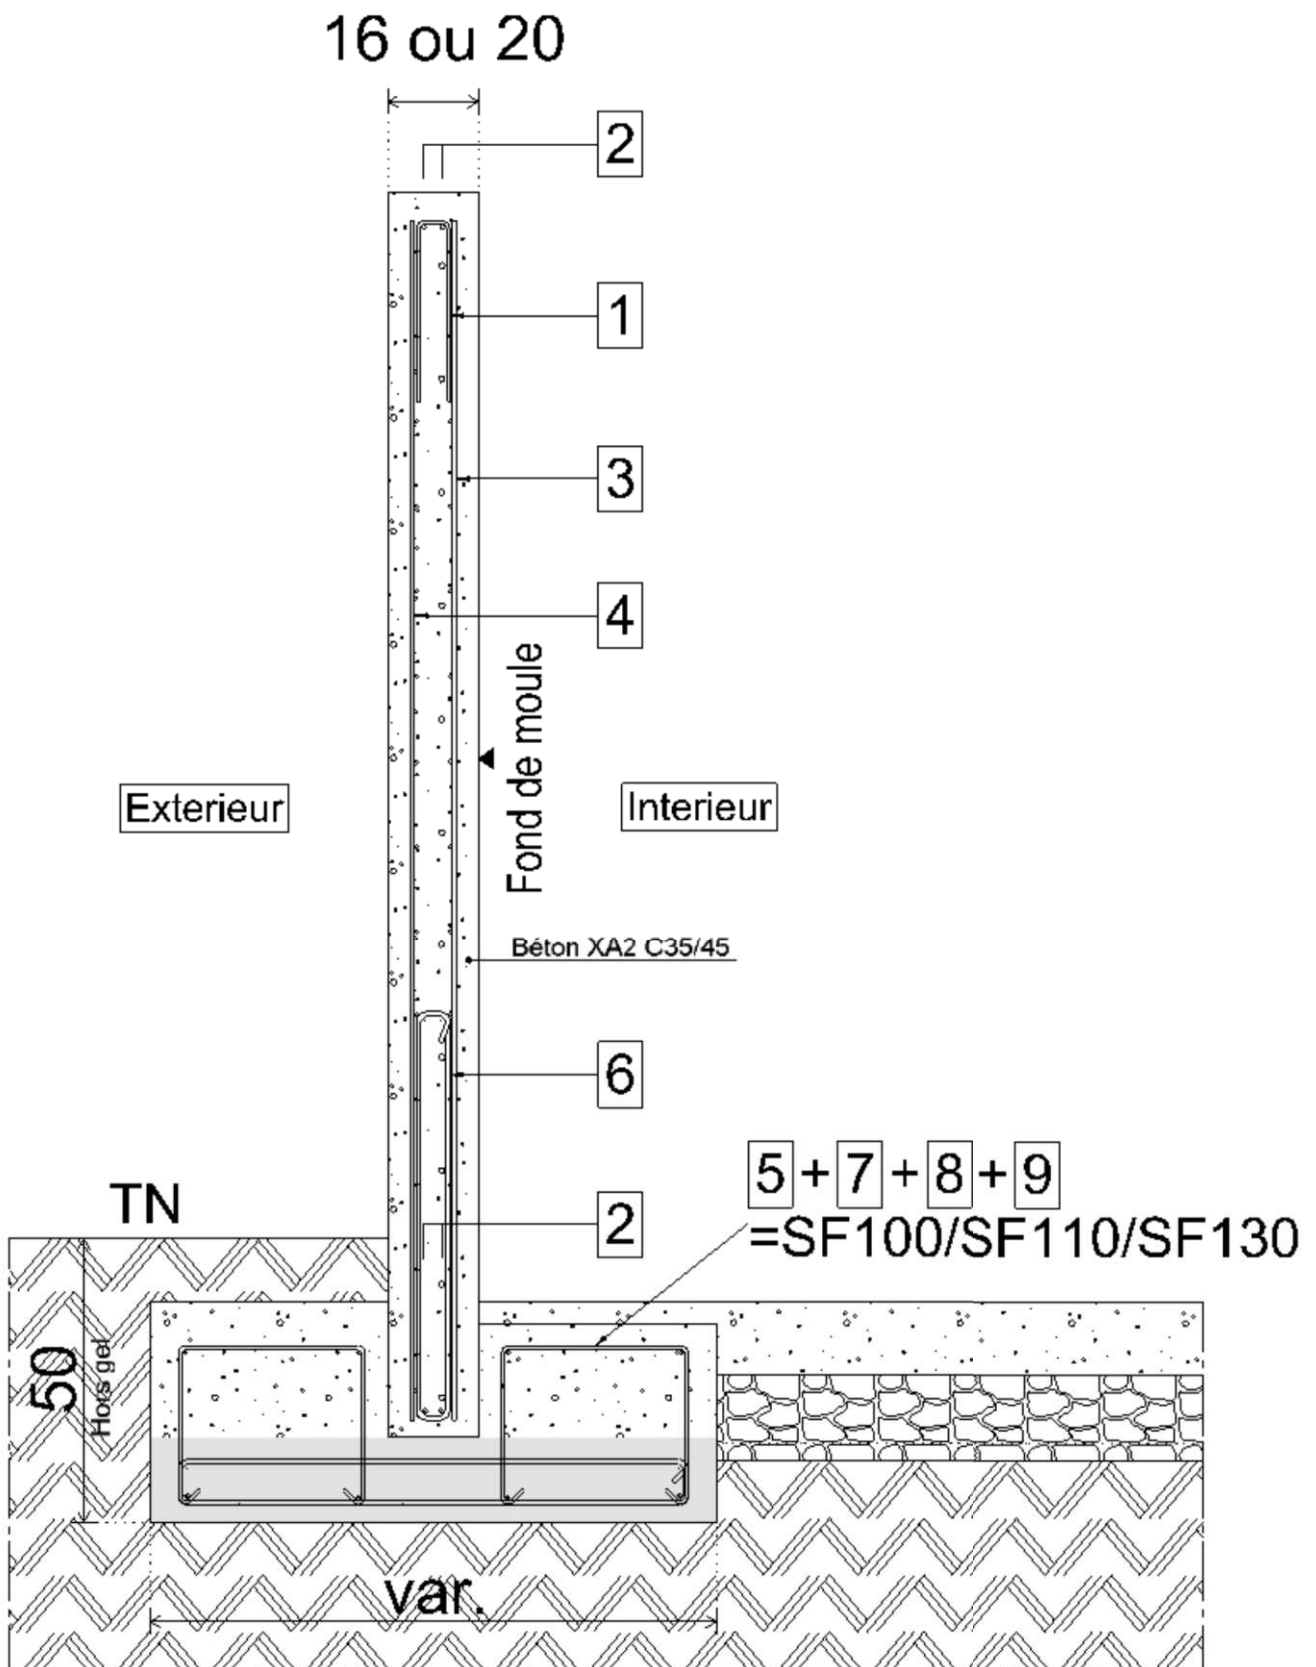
Coupe sur voile extérieure fumière (épaisseur 16 ou 20cm)
